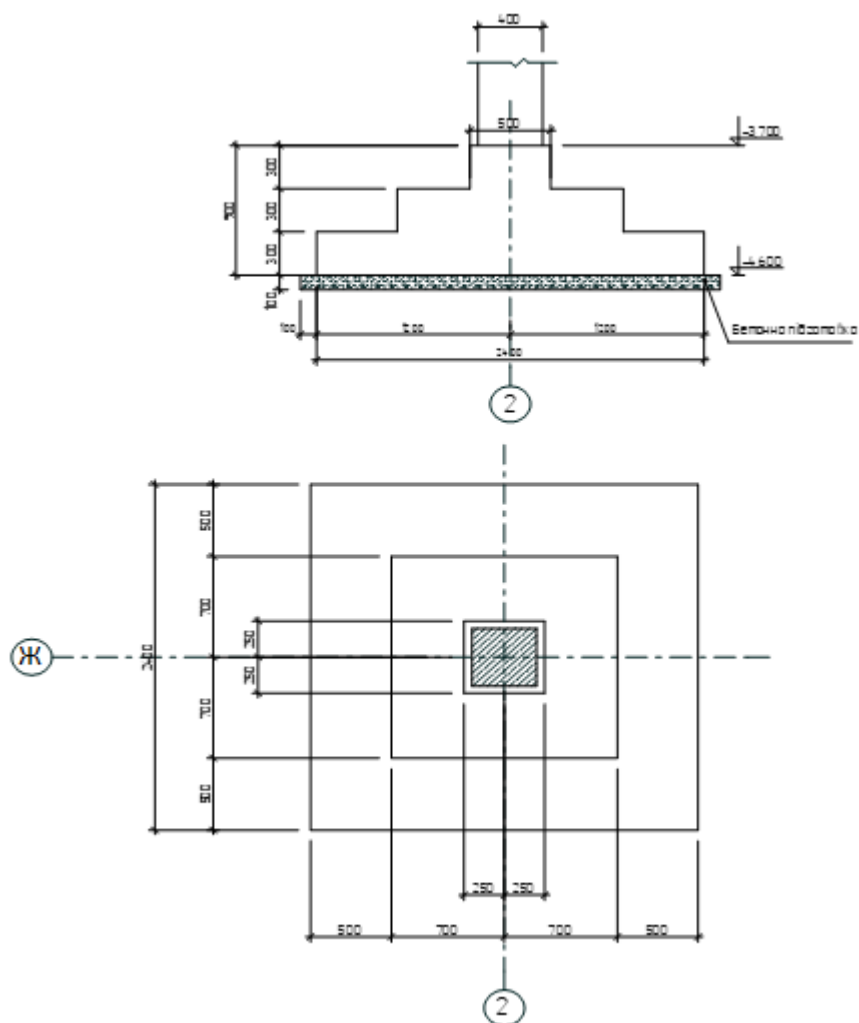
Конструктивне рішення стовпчастого фундаменту мілкового закладання на перетині осей (Ж – 2)
